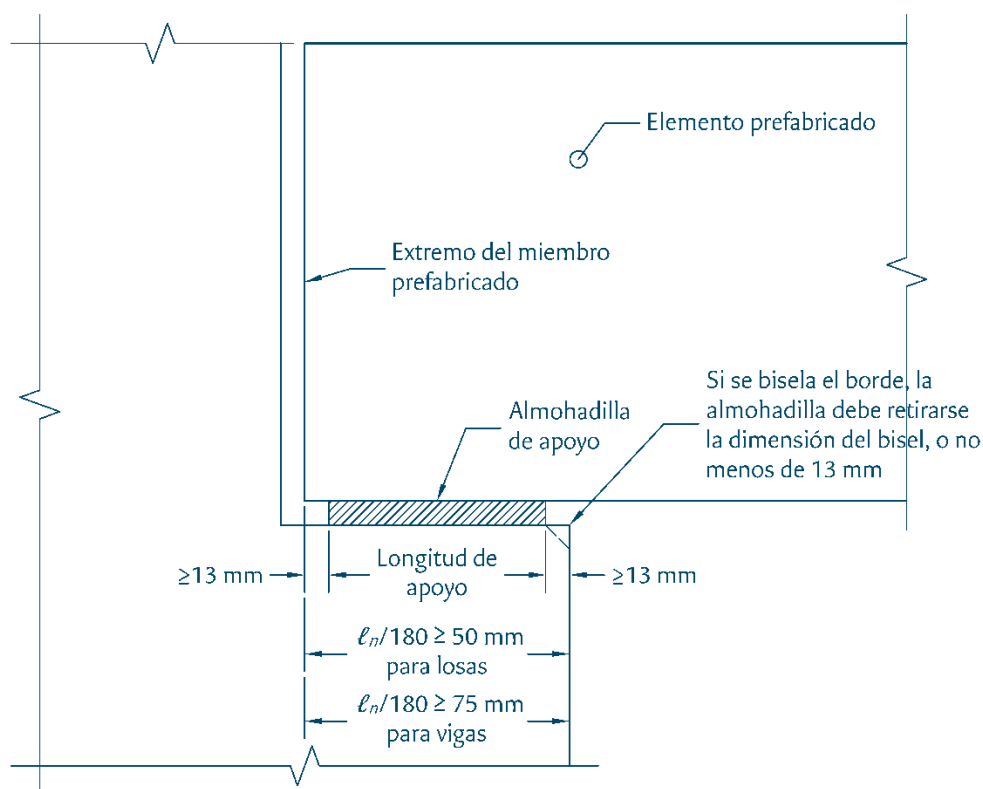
Longitud del apoyo. Referencia: 5.12.2.13.
